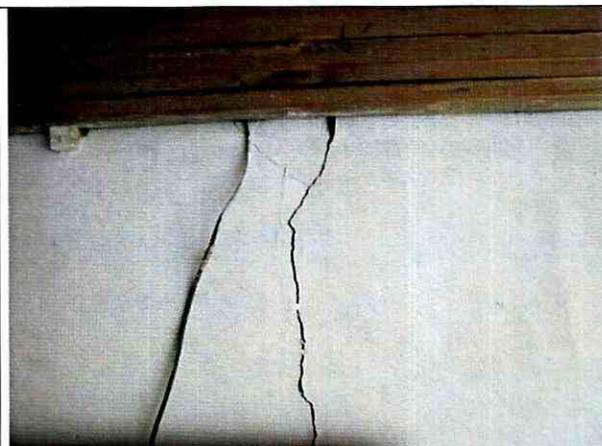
Grieta en muro del costado norte, segundo piso.
